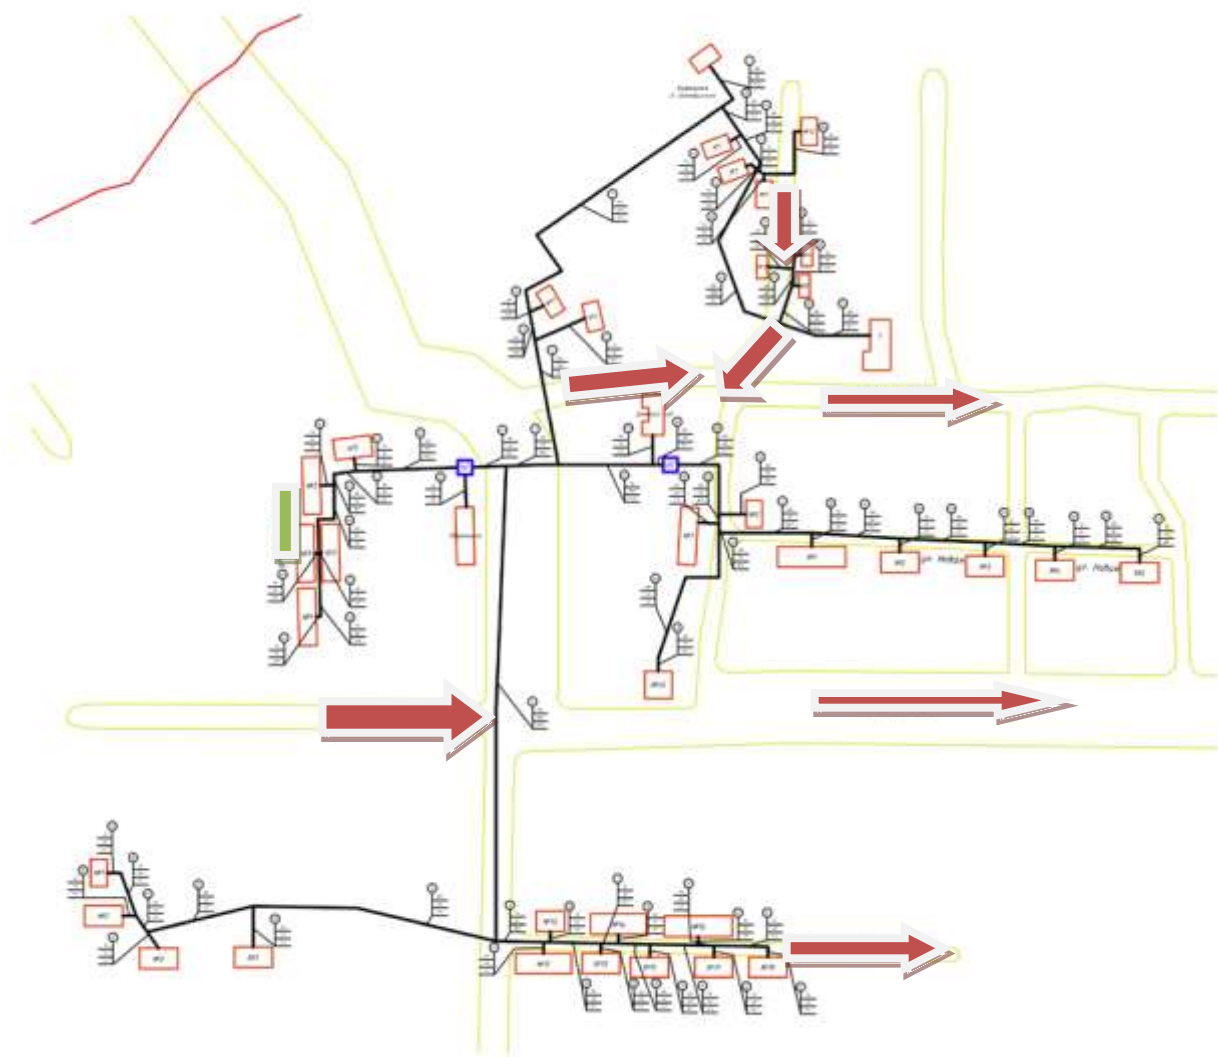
Схема тепловой сети котельной улицы Строительная
